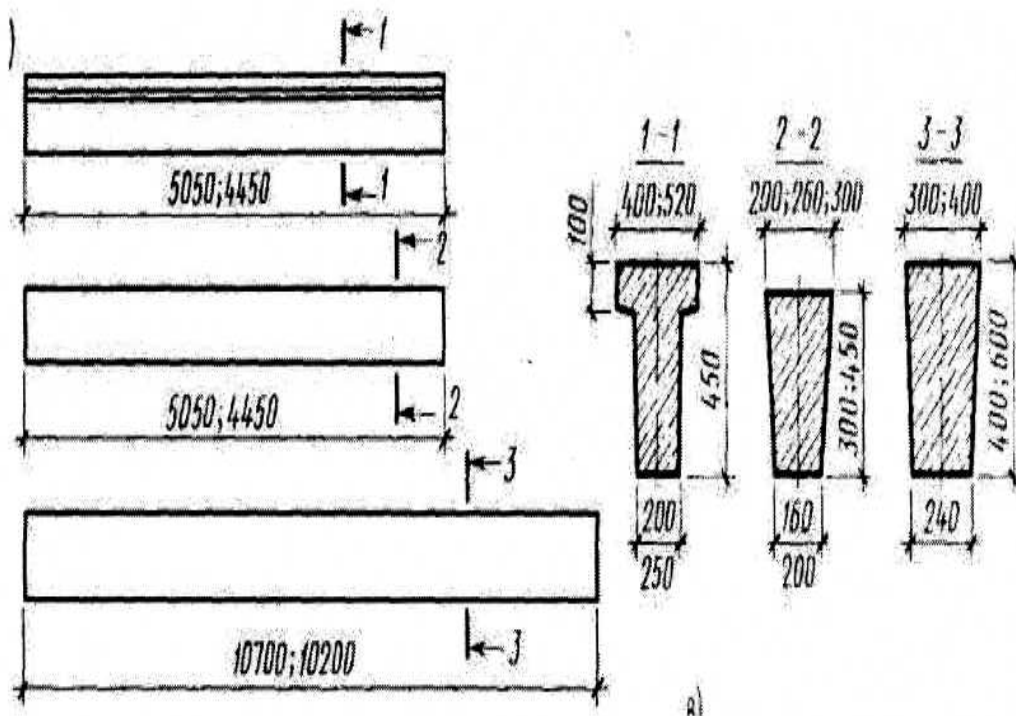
Фундаментные балки для шага колонн 6 и 12 м [23]
